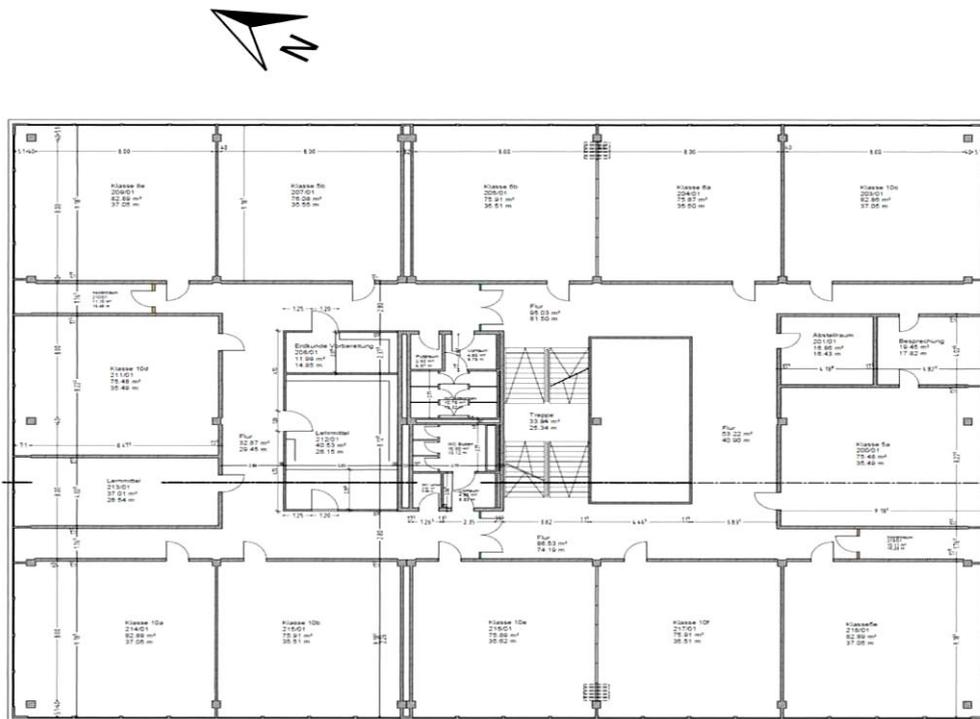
Grundriss des 1. Obergeschosses der Theodor-Heuss-Realschule.
